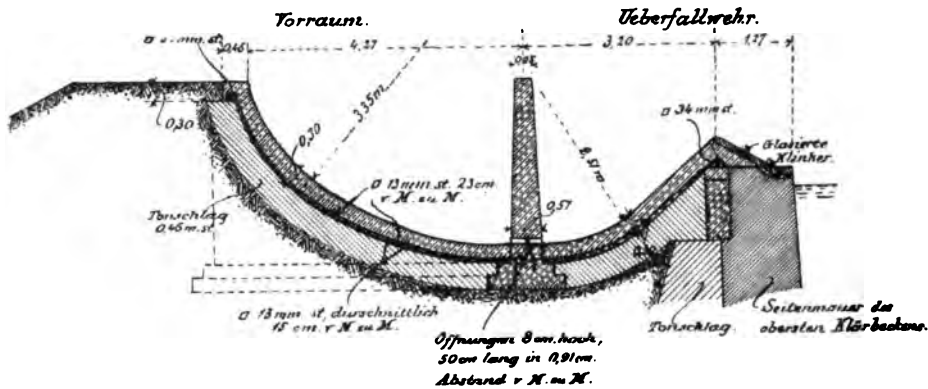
Überlauf der Kläranlage der Wasserwerke von St. Louis. Querschnitt.
